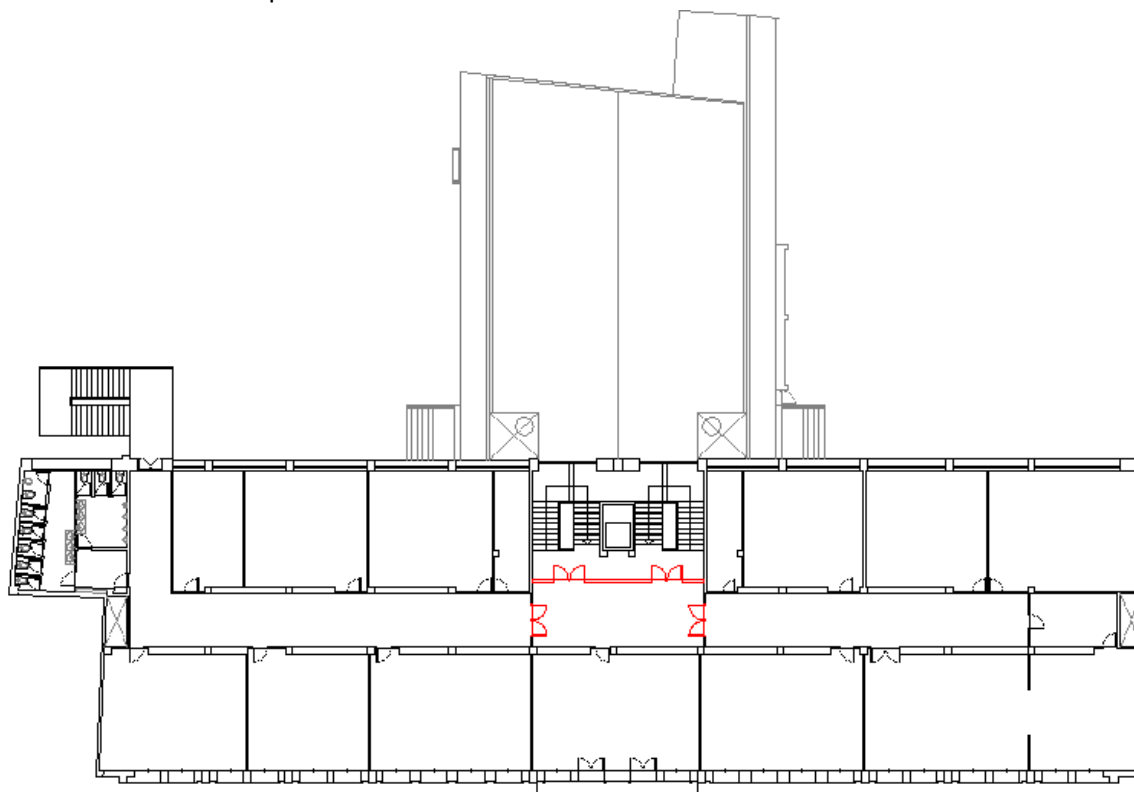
Propuestas de actuación en puertas planta segunda. Fuente: Elaboración propia.
